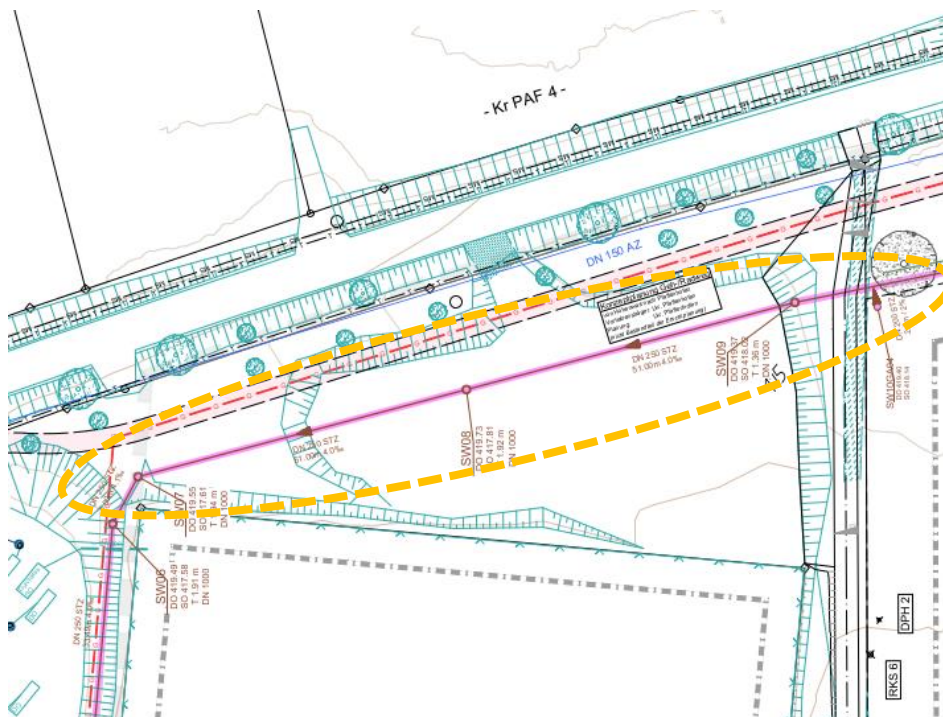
Ausschnitt Erschließung „Ziegelstadeläcker III, Lageplan Sparten¹⁰
